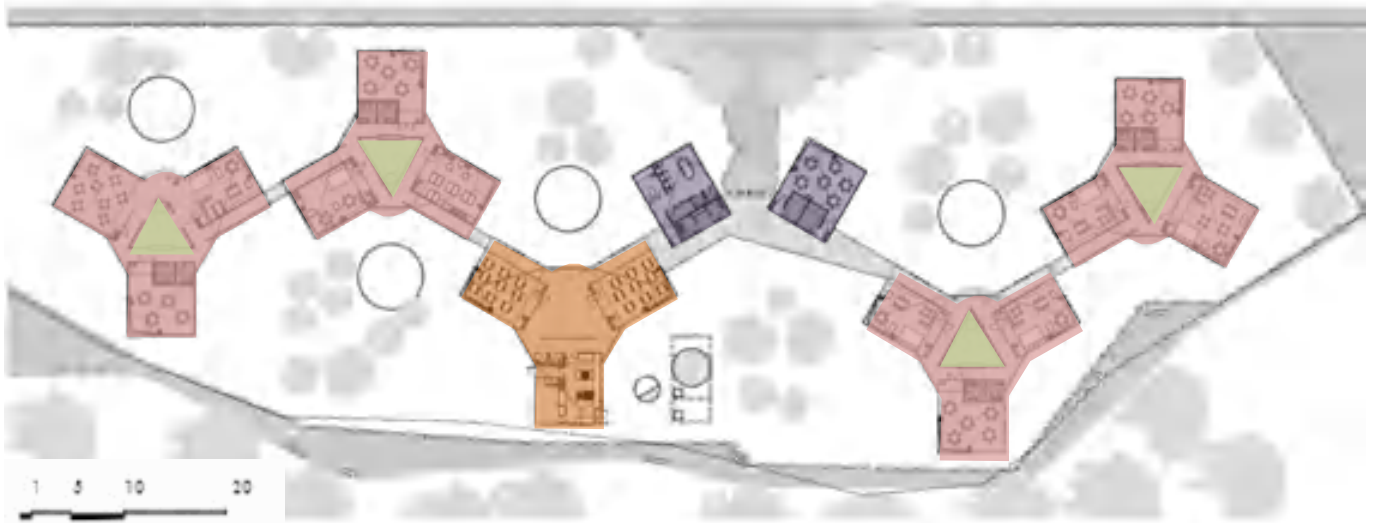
Planta baixa zoneada Kindergarten Timayui
